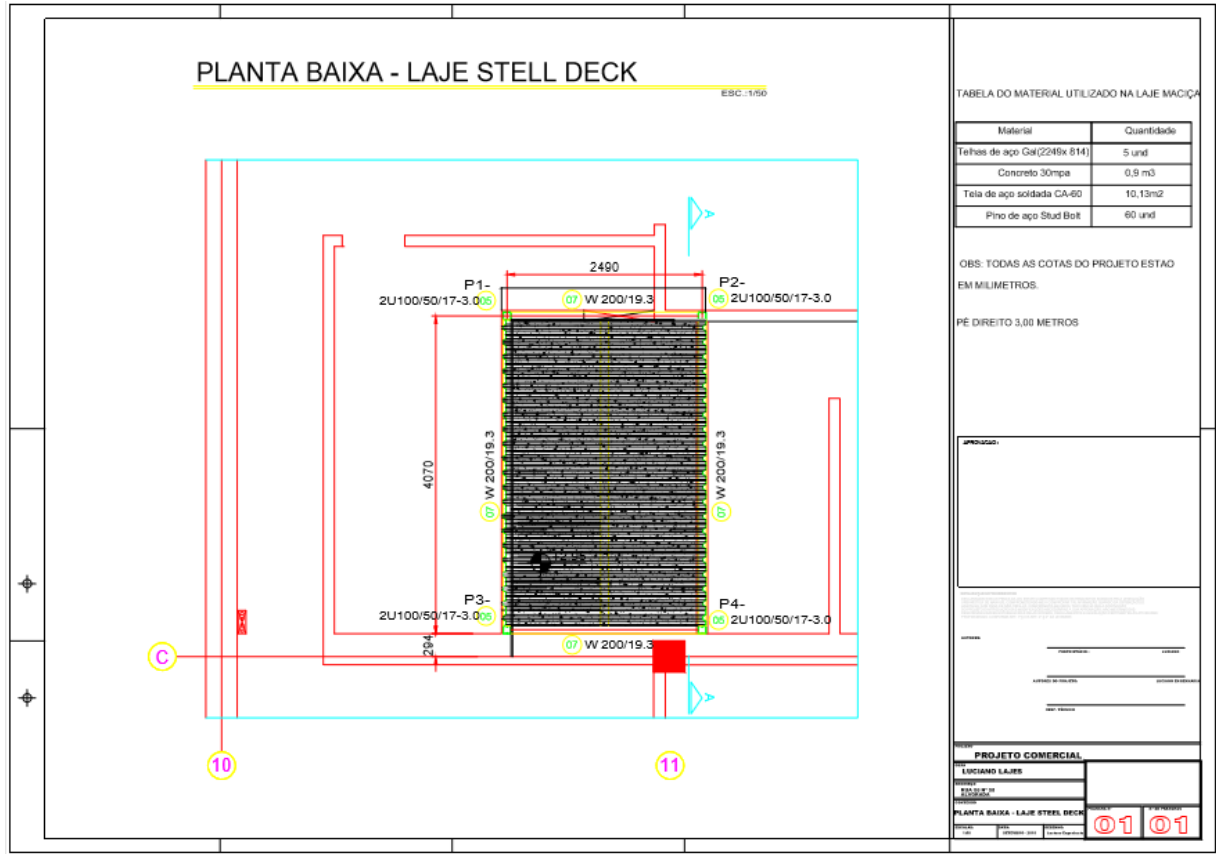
planta baixa laje Steel Deck. Fonte: Autoria própria, 2018.
